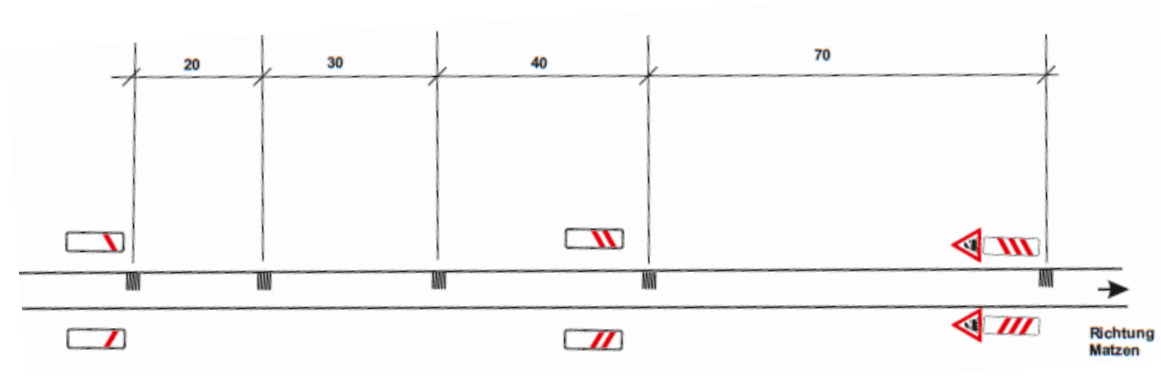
Gerundete Abstände der Rüttelstreifen im Lageplan
